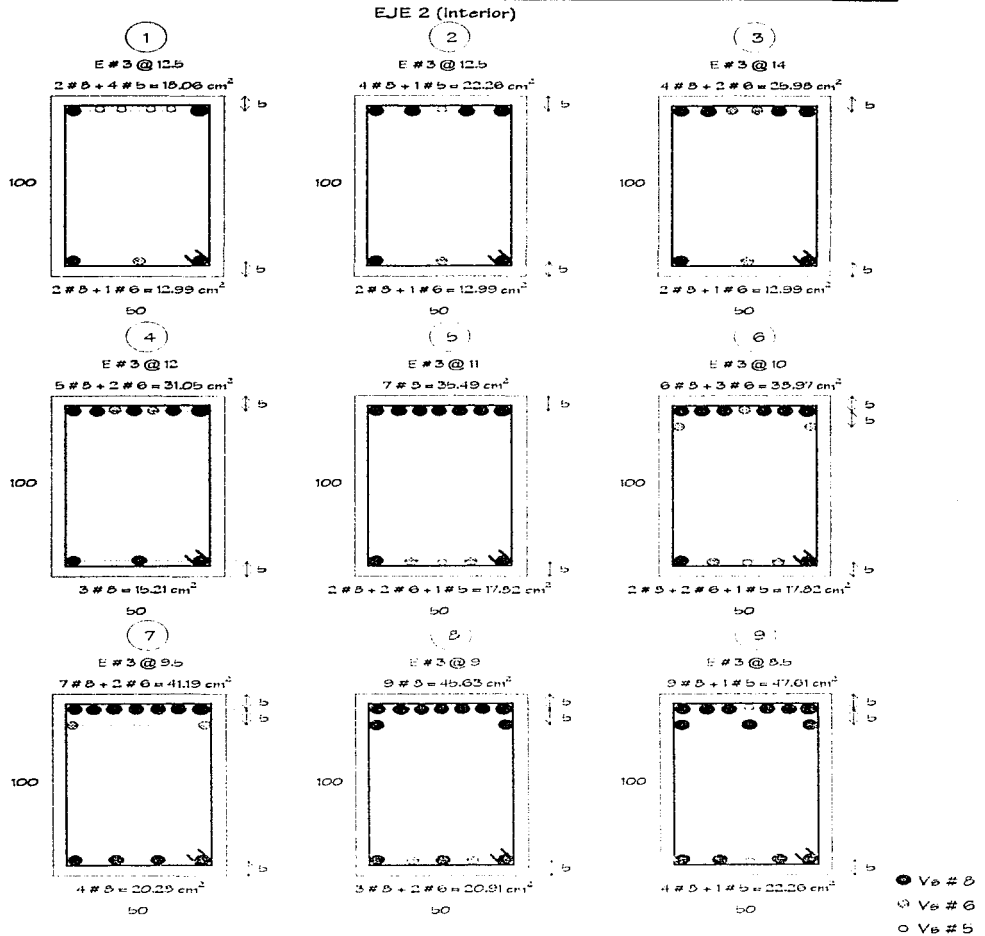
a).- Tipo de armado de las vigas del eje 2 del edificio de 17 niveles diseñado en la zona III
